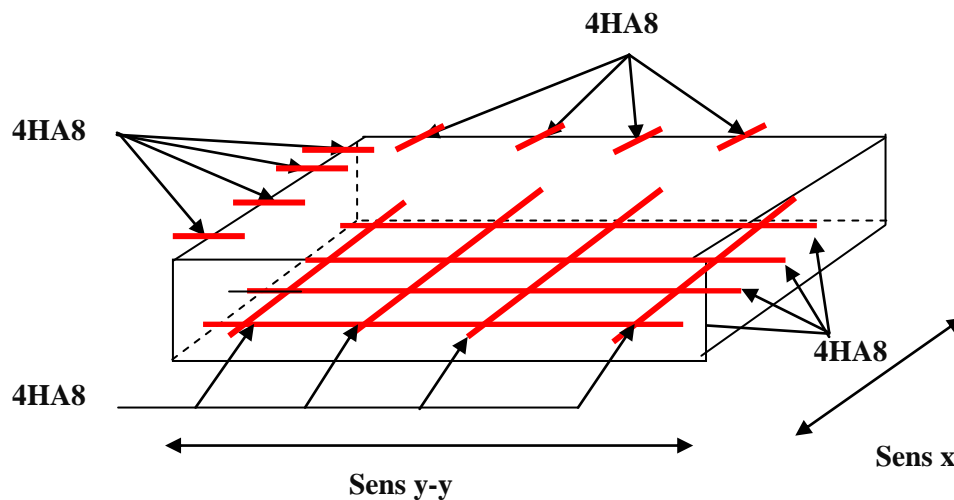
Schéma de ferrailage de la dalle d'ascenseur.
